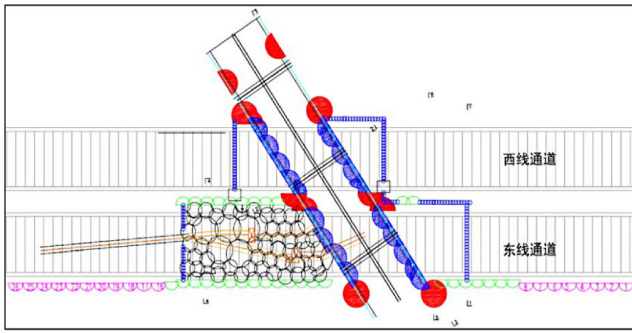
压力污水箱涵 + 支管拖底 MJS+ 双轴隔离与封堵墙加固平面图
